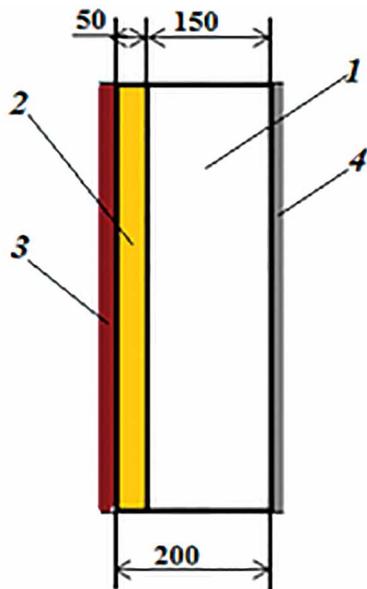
Схема каркасной стены с утеплением из металлизированного пенополиэтилена:
